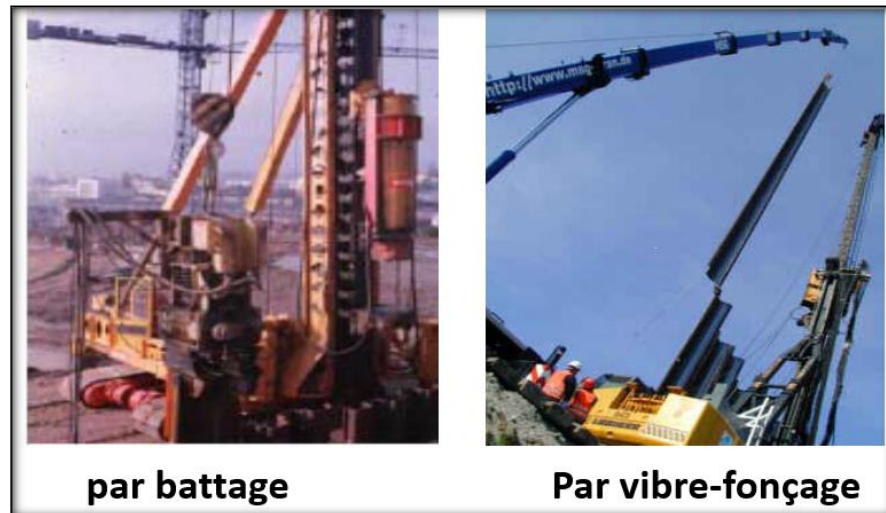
Installation Les piles de tôle d'acier (Les palplanches en acier)
